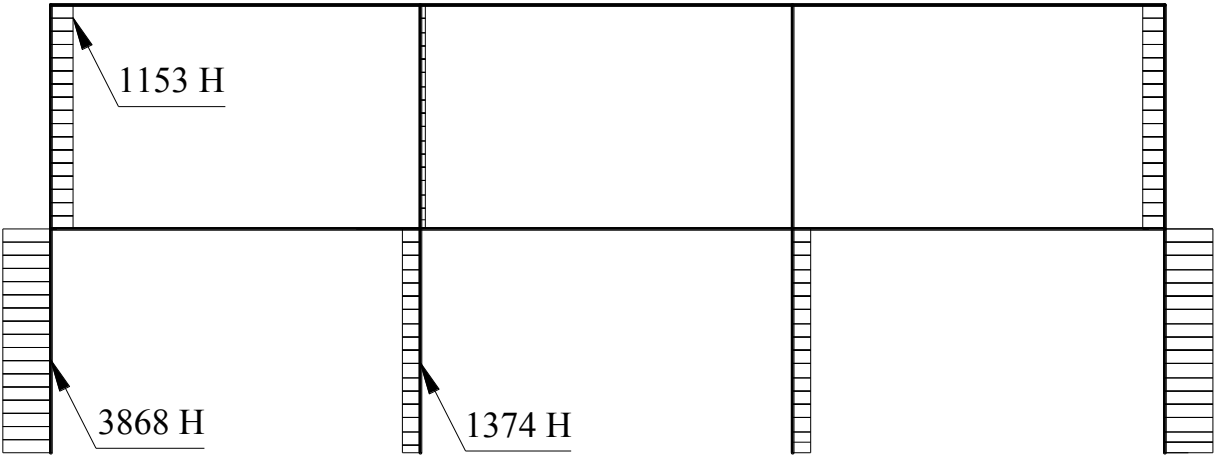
Эпюра поперечных сил для 2 Варианта тепловой нагрузки
